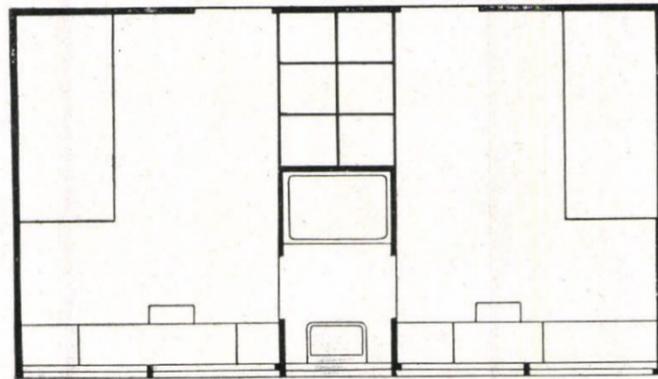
Grundriss einer Wohneinheit im *Kolház
